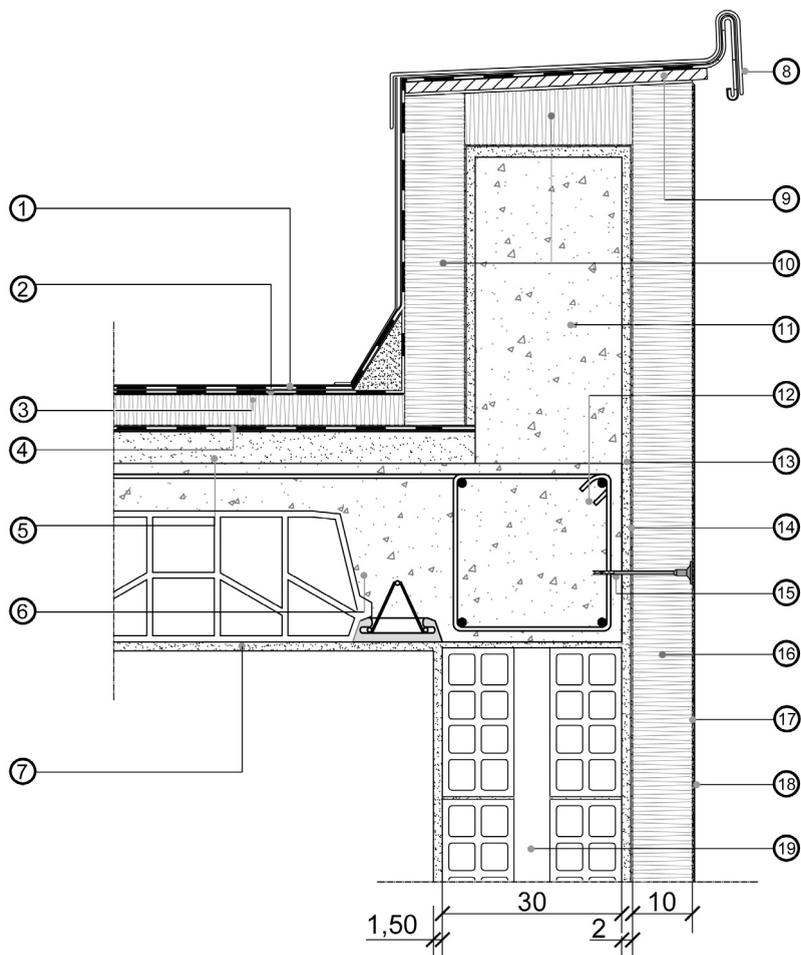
Dettaglio tecnico in sezione verticale di una soluzione di raccordo alla copertura piana di un sistema di isolamento a cappotto ETICS su una struttura edilizia preesistente.
